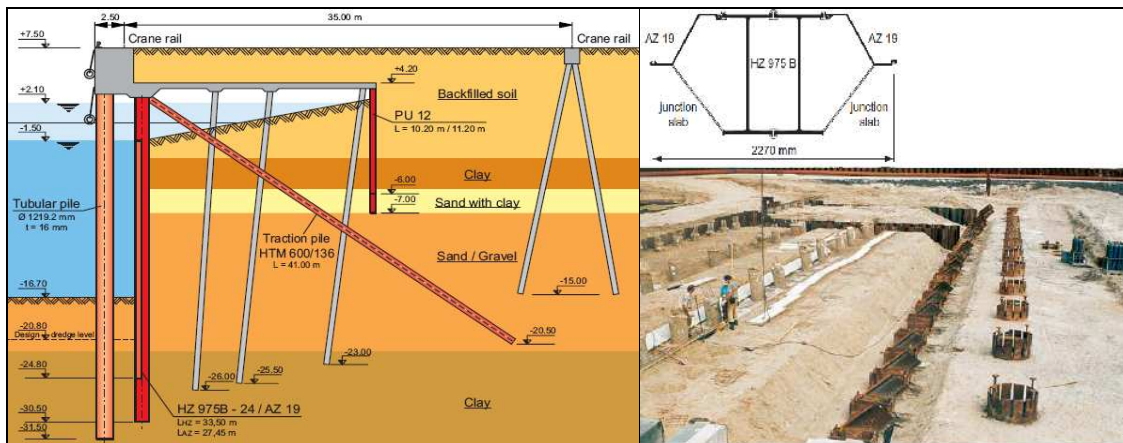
Corte-tipo e construção de um cais acostável do “tipo dinamarquês” em Altenwerder, Alemanha [64].
